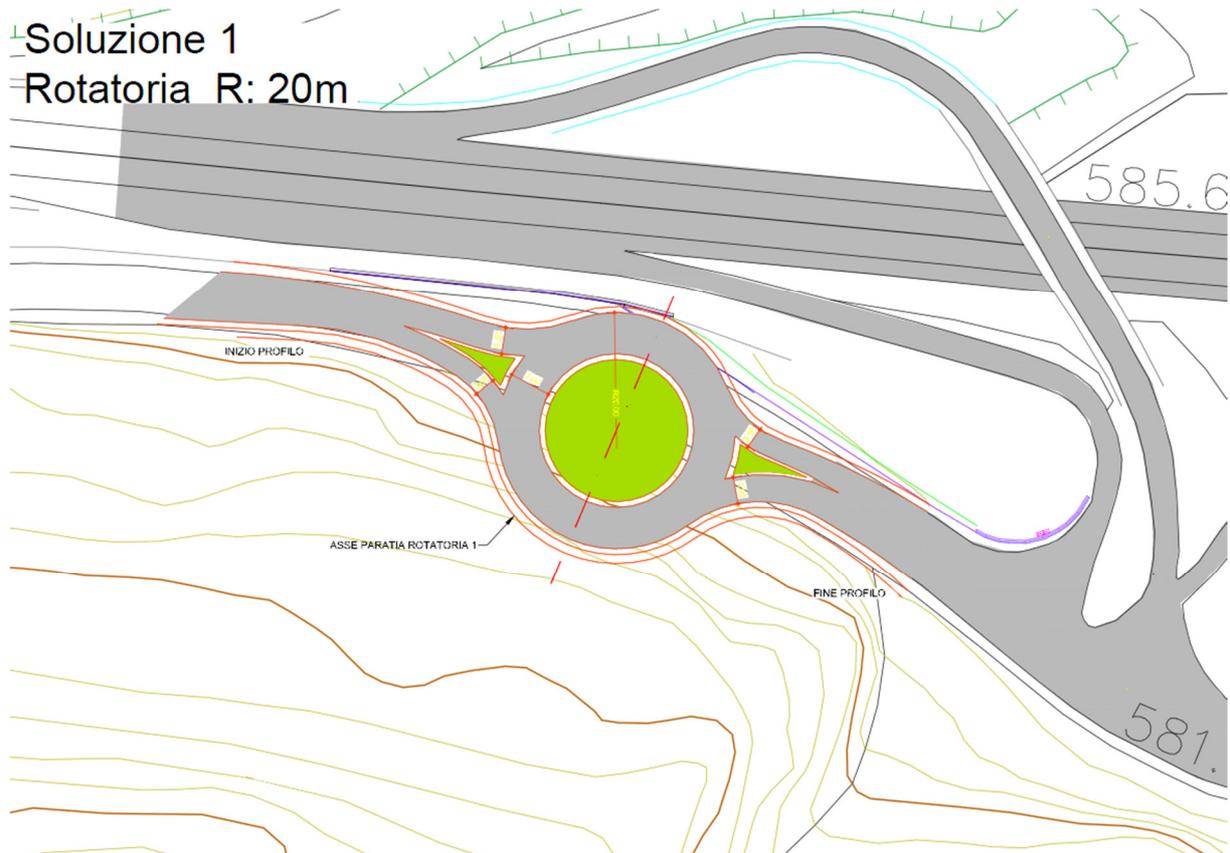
Planimetria Soluzione alternativa n. 1 rotatoria r esterno = 20 m
